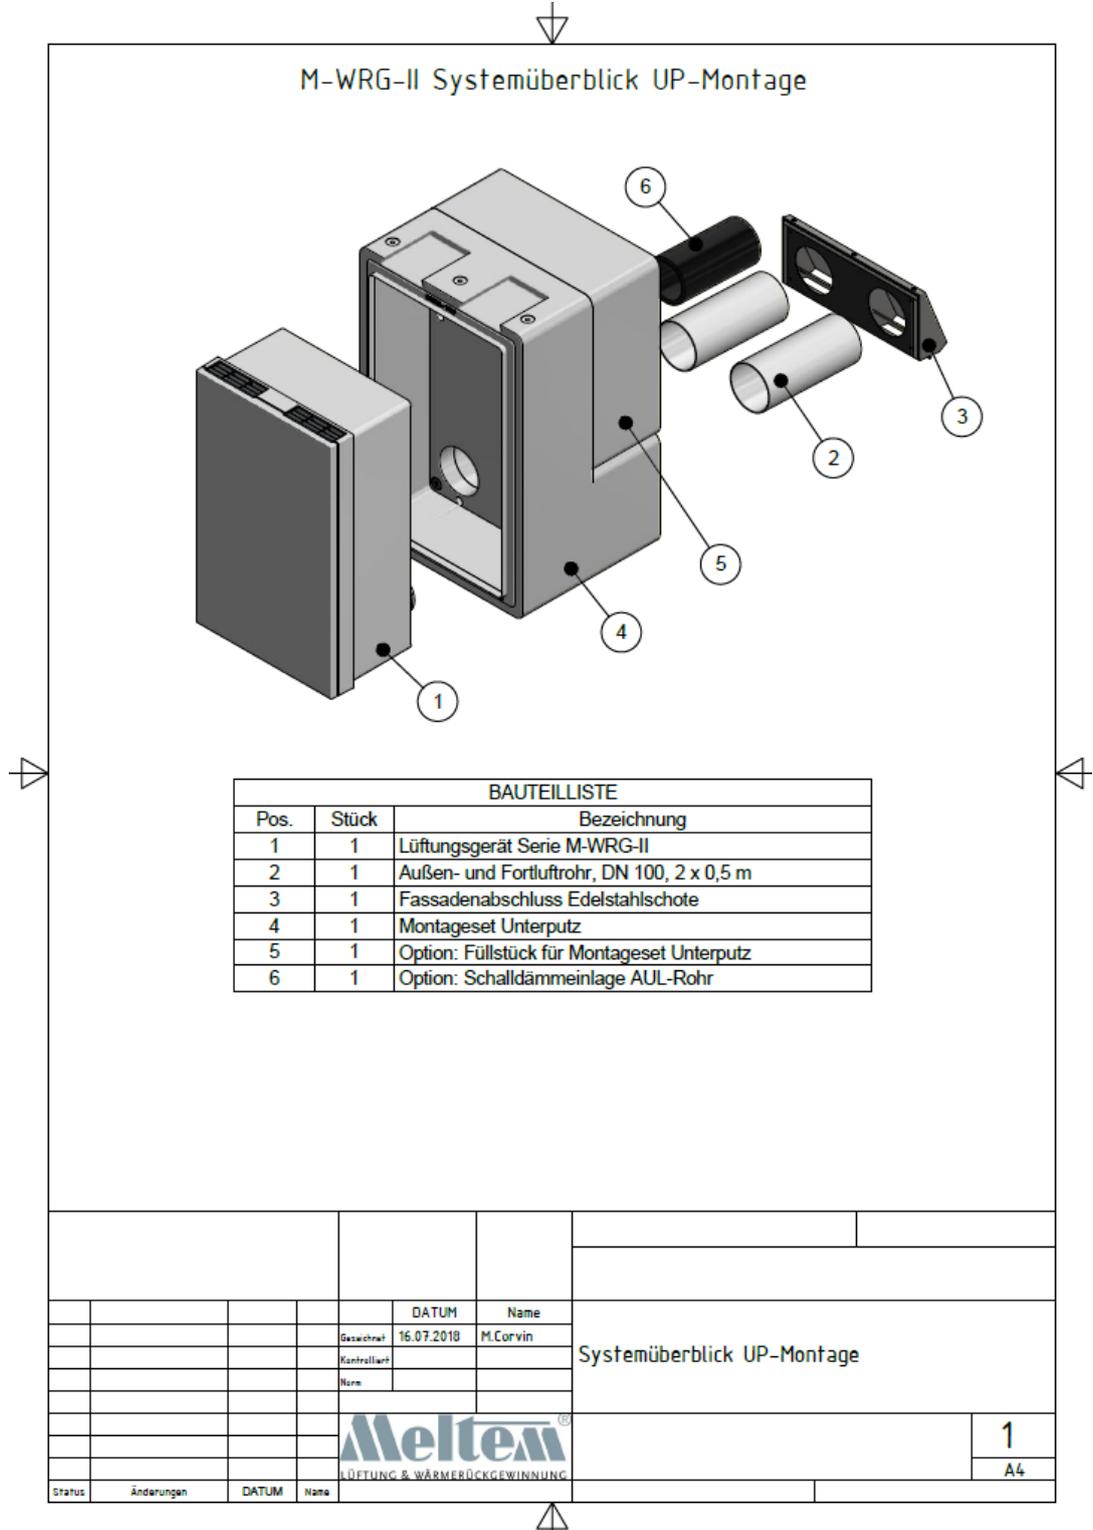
UP-Einbau (Ein-Raum-Variante): Explosionszeichnung.
